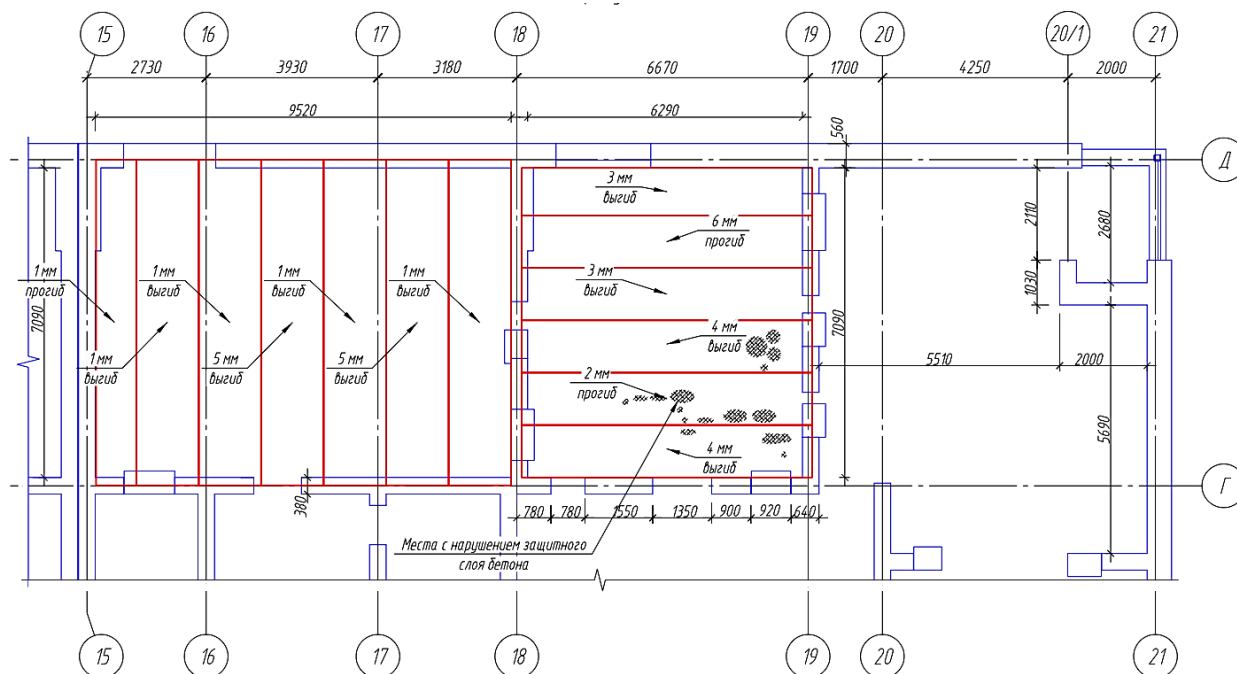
Фрагмент плана плит перекрытия технического этажа по результатам обследования
